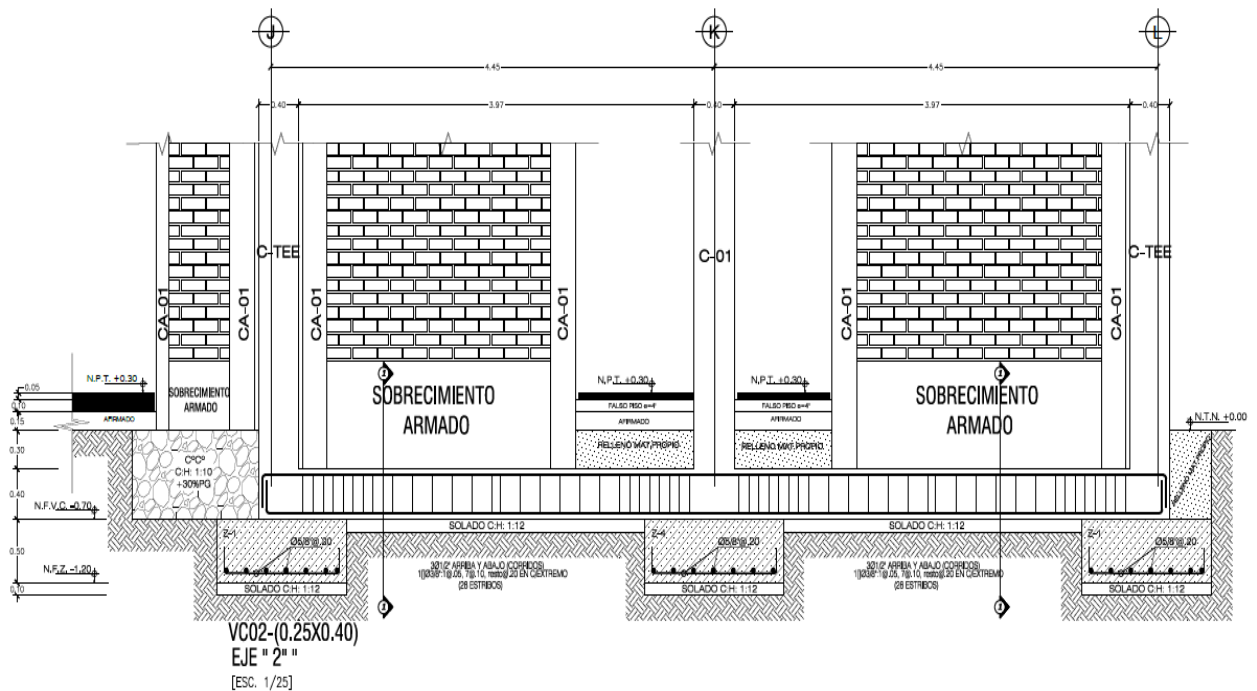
Corte transversal de la Viga de Cimentación del módulo 01 ubicada en el eje "3"
